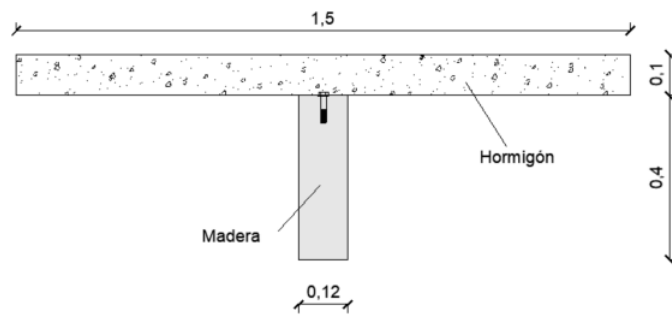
Sección de viga compuesta en entrepiso con ancho colaborante de hormigón.
